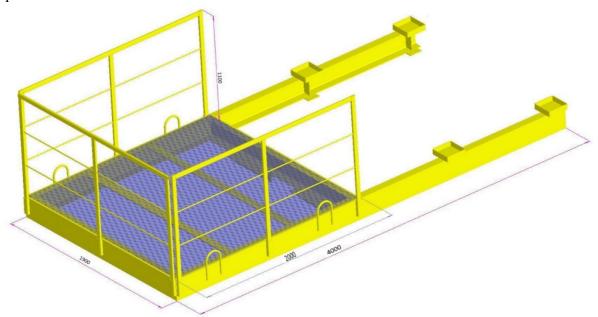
Грузоприемная площадка ВП-1 с металлическим настилом
